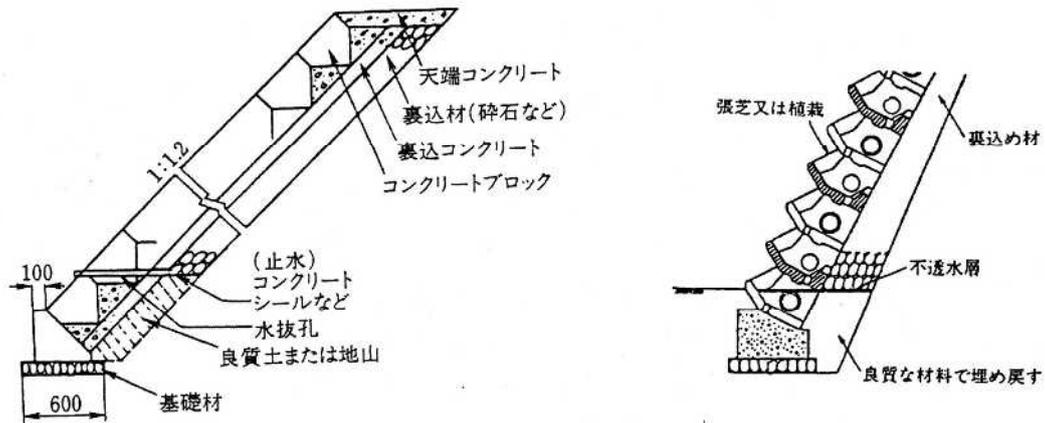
コンクリートブロック張工の例・緑化ブロックの例
